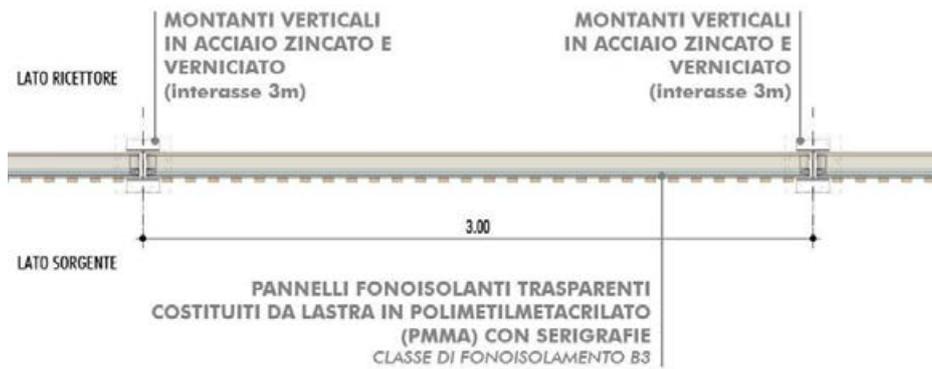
SEZIONE ORIZZONTALE – PANNELLO TRASPARENTE
